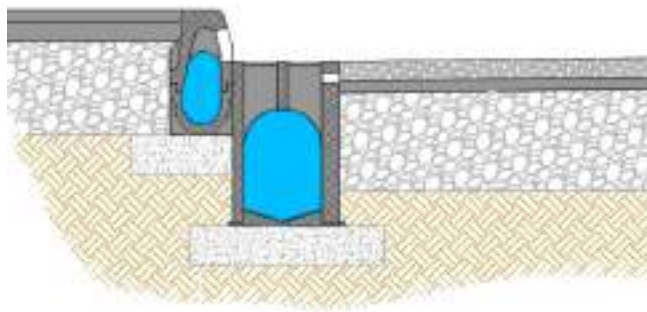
Sezione asfalto drenante con canalette di accumulo
